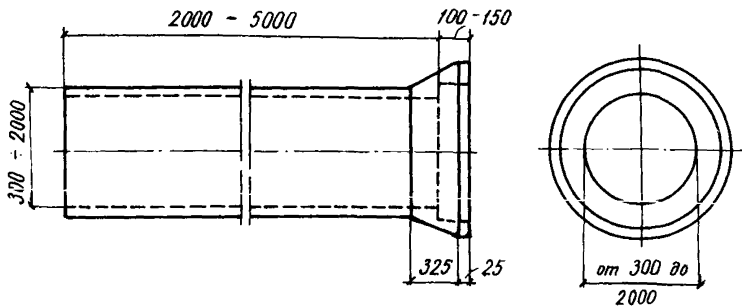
Конструкция опалубки и стыкового соединения трубы
